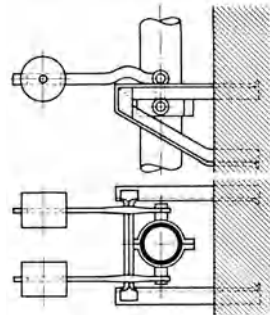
Konsol mit Hebel und Gewichtsausgleich.
